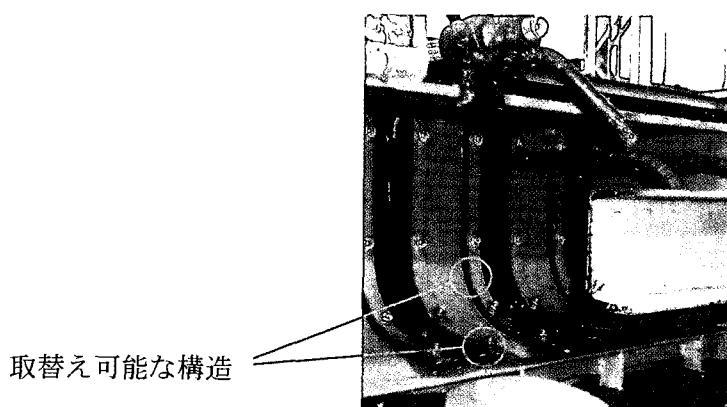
ループ鉄筋挿入部のゴム枠構造の例
